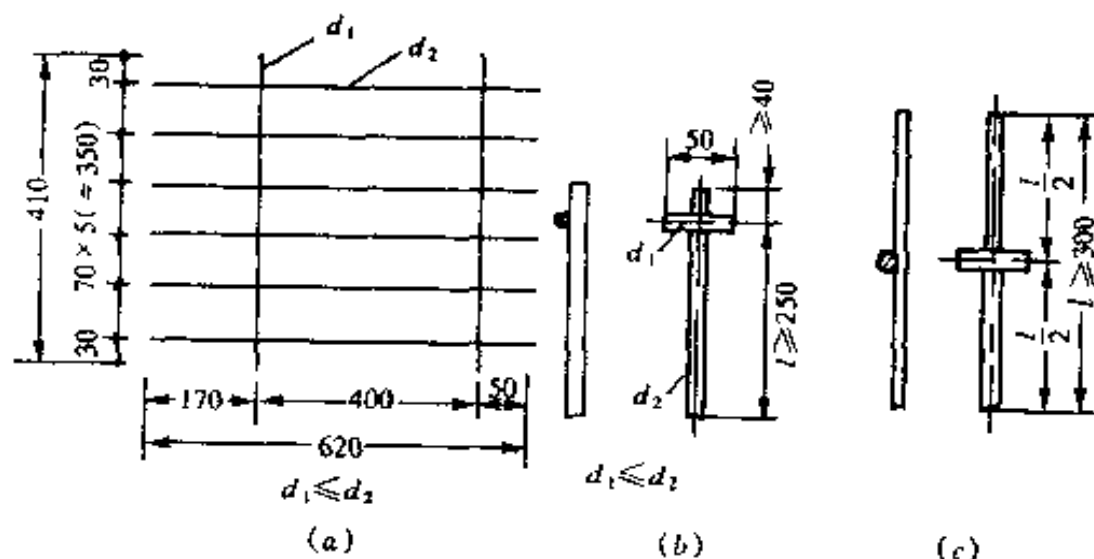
钢筋模拟焊接试验网片与试件
